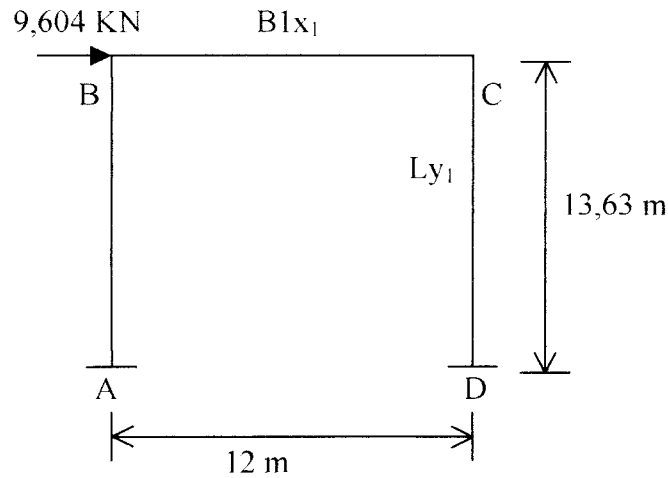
Penempatan gaya yang bekerja pada portal ujung struktur jembatan rangka baja.
